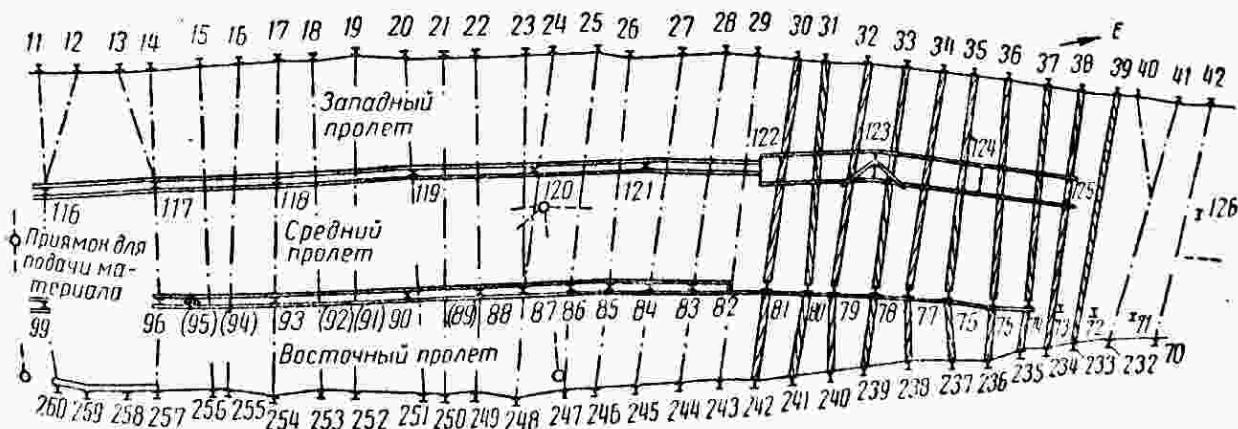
План участка обвала котлована Берлинской подземной железной дороги
